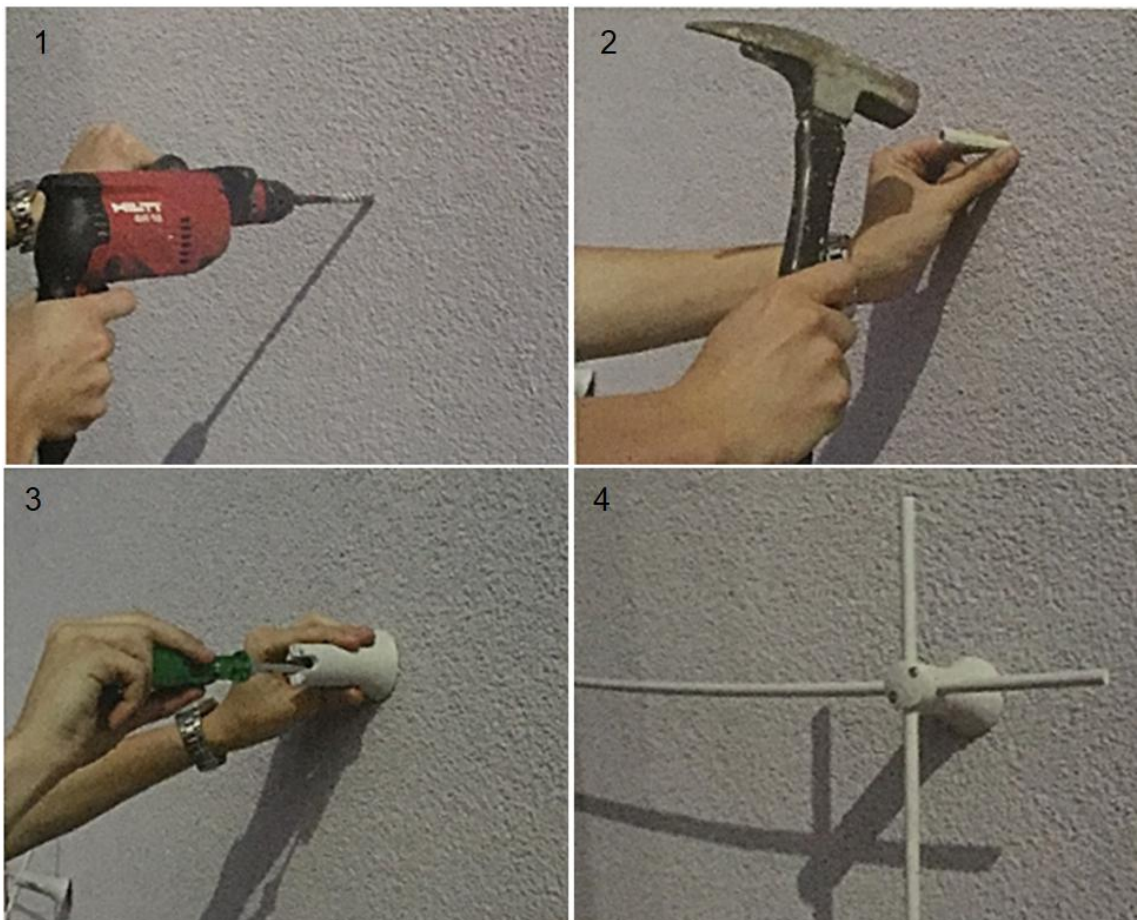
Montage eines Klettergerüsts an einer ungedämmten Betonwand: 1. Loch bohren, 2. Dübel einschlagen, 3. Abstandhalter anschrauben, 4. Rankstäbe befestigen. © Brandmeier Begrünungssysteme, Inzlingen [GUN04]
